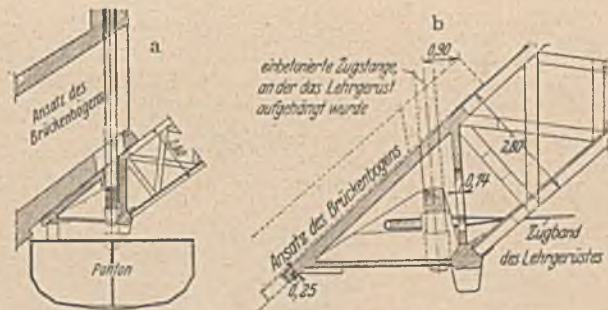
und b. Kämpfer des Lehrgerüsts.
